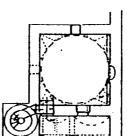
مسقط أفقى لمسجد طاش بقونية (عن : Aslanapa) .
